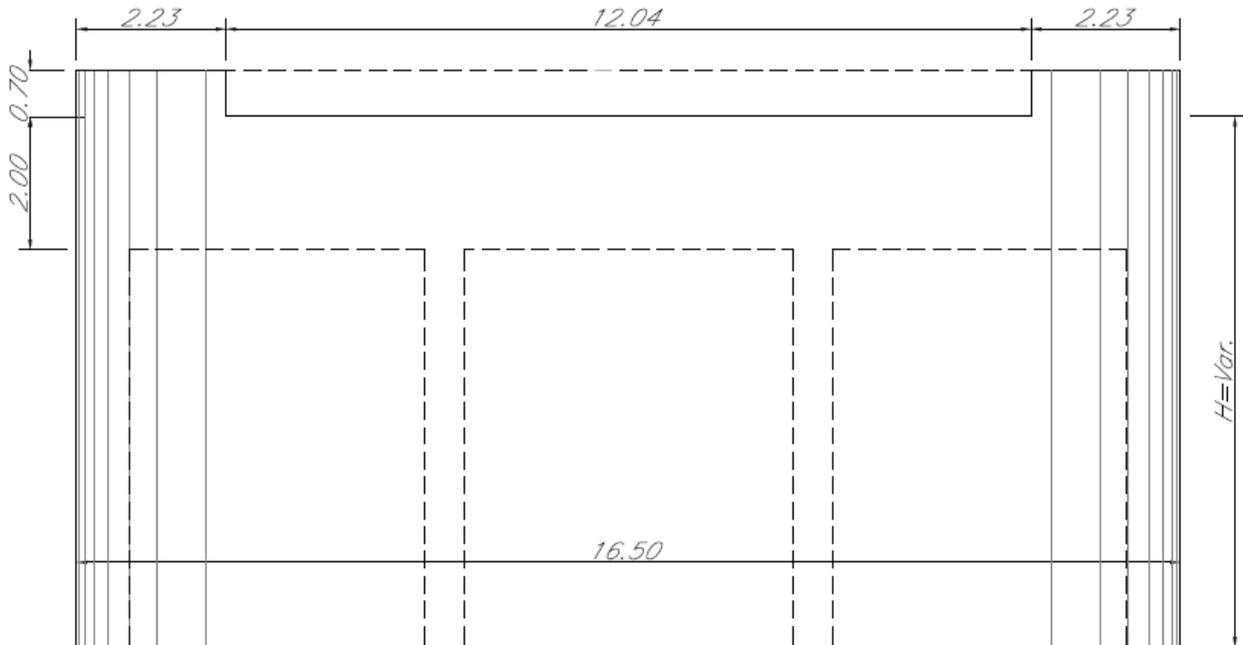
Prospetto trasversale pila Tricellulare doppio binario 16.50m x 5.00m
